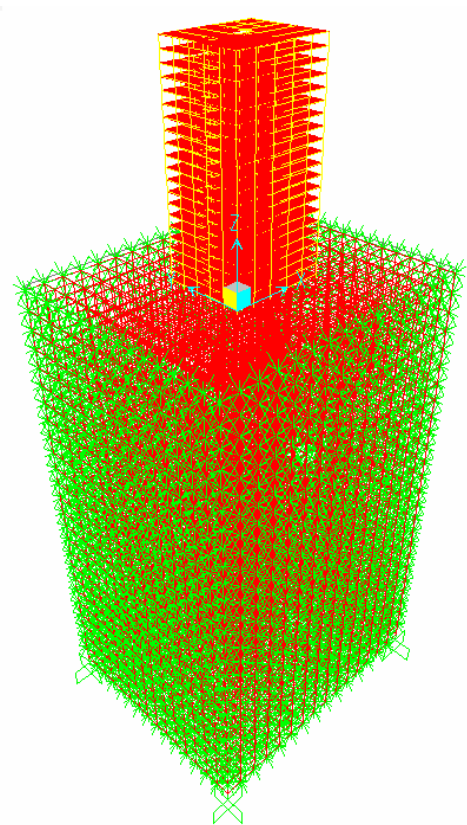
Estrutura reticulada com elementos de barra e de placa (esbelta e espessa), apoiados em elementos sólidos restringidos.
